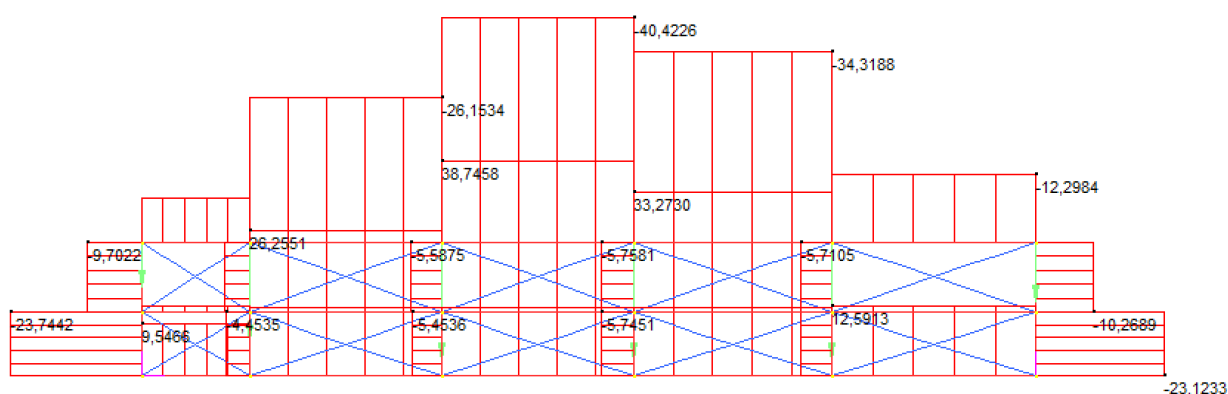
Schema statico e deformato della trave reticolare a cui viene assimilato il sistema di controventamento.
